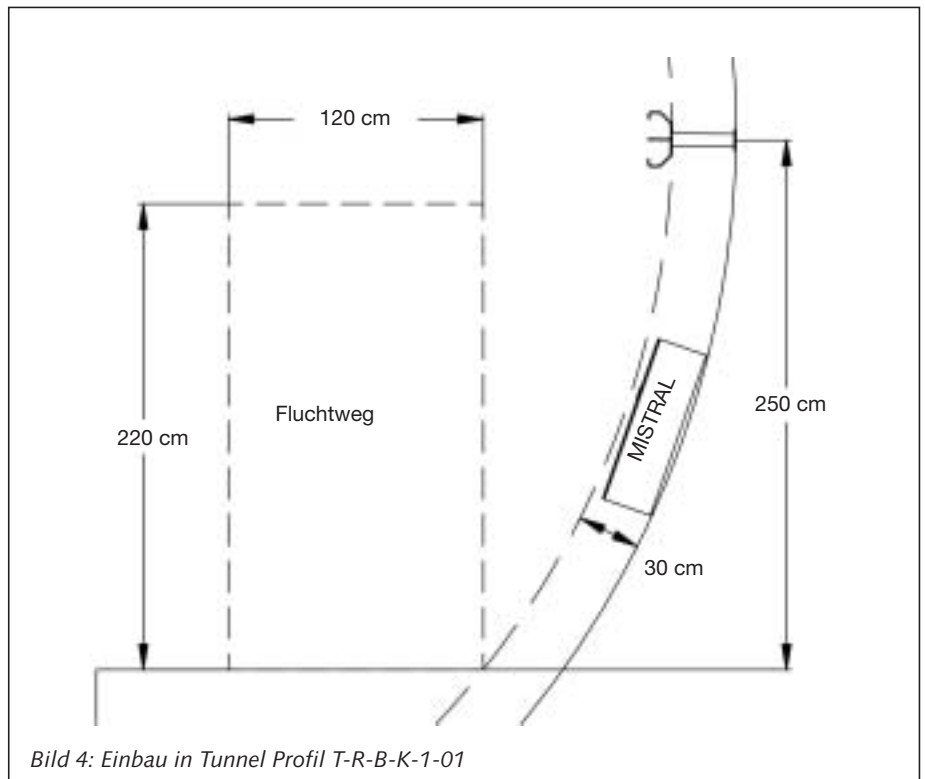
Einbau in Tunnel Profil T-R-B-K-1-01
